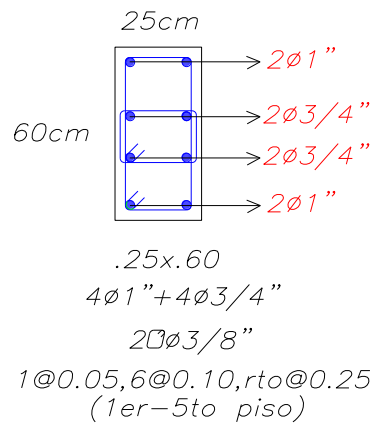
sección de columna 25x60 con detalle final de refuerzo típico
